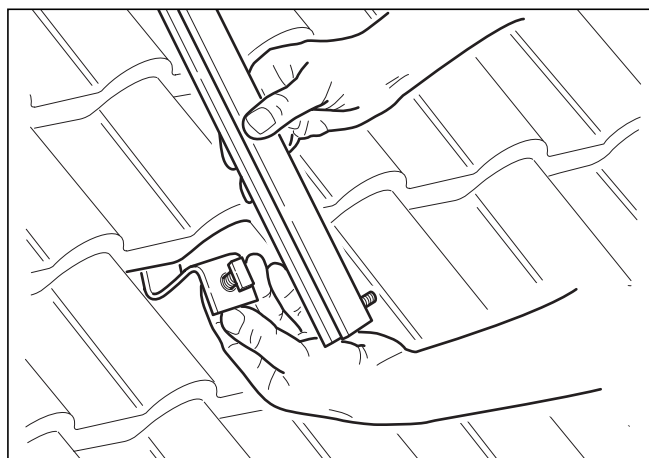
Alleen bij verticale collectormontage: vier collectorstenen voor montage op dak erop schuiven en positioneren.
